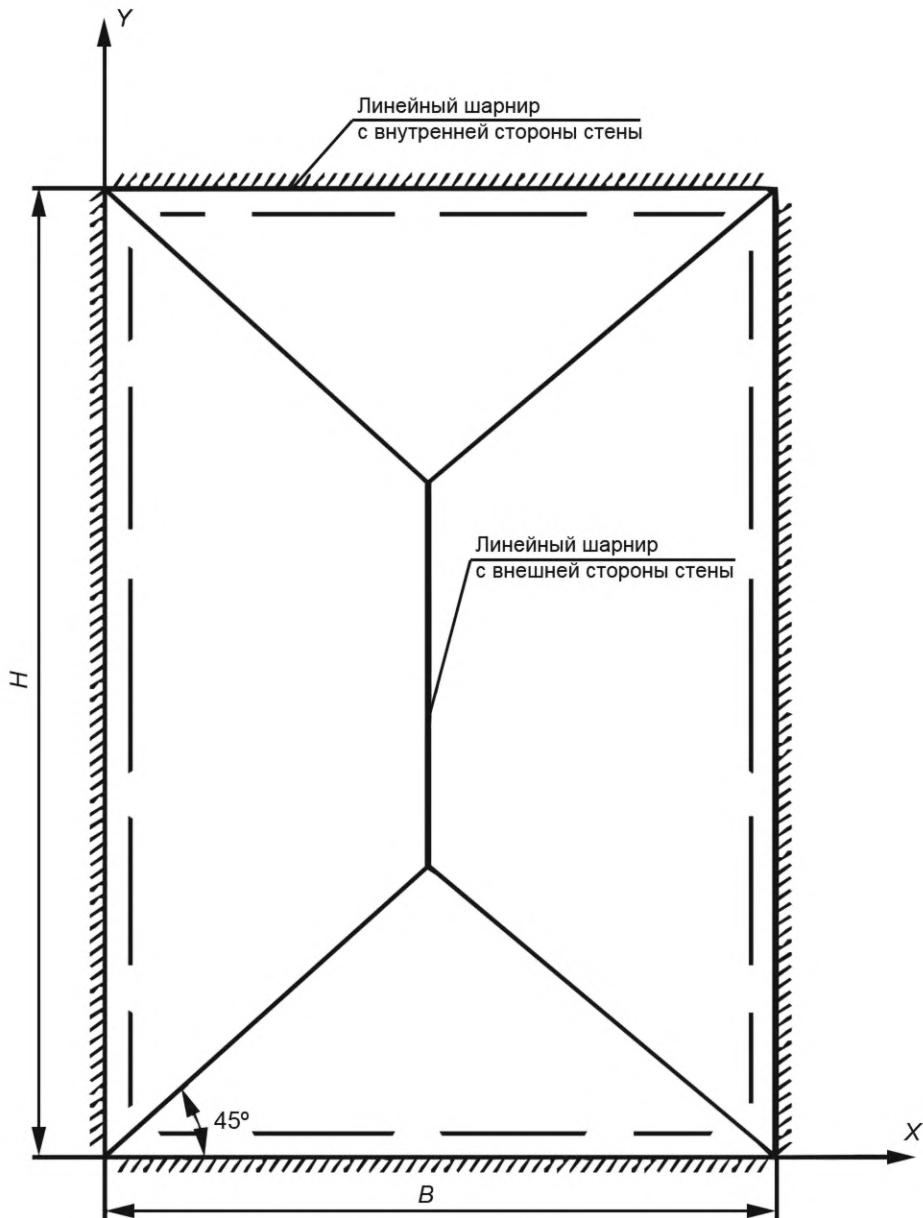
Кинематическая схема разрушения стен (перекрытия) глухих помещений (вид с внешней стороны помещения)
